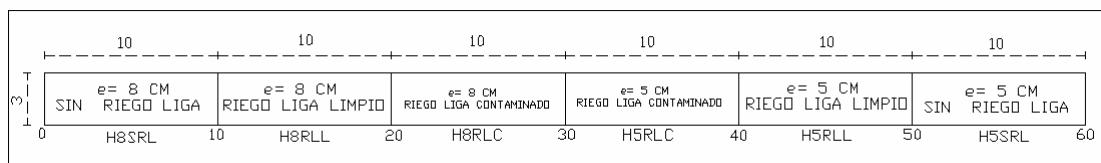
Esquema de tramos de pista prueba sobre hormigón
